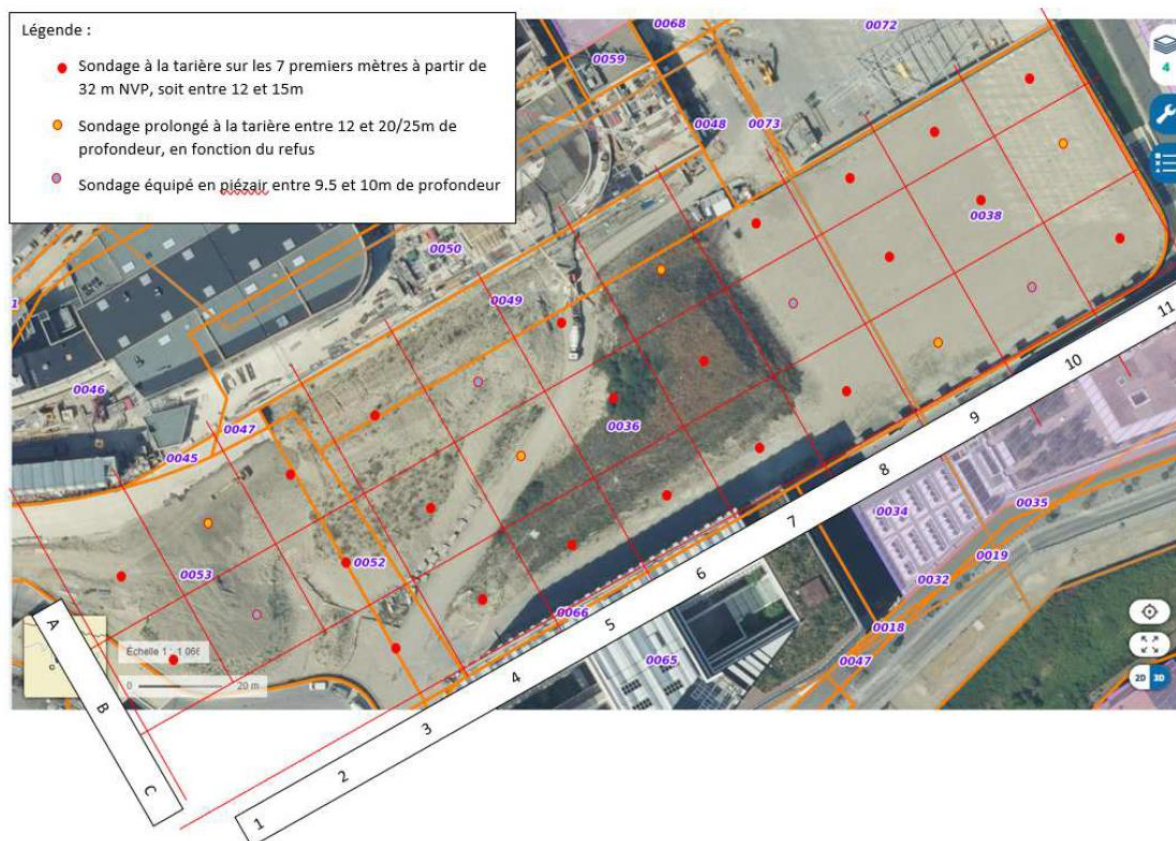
Plan d'implantation des sondages (source : GEOLIA)
